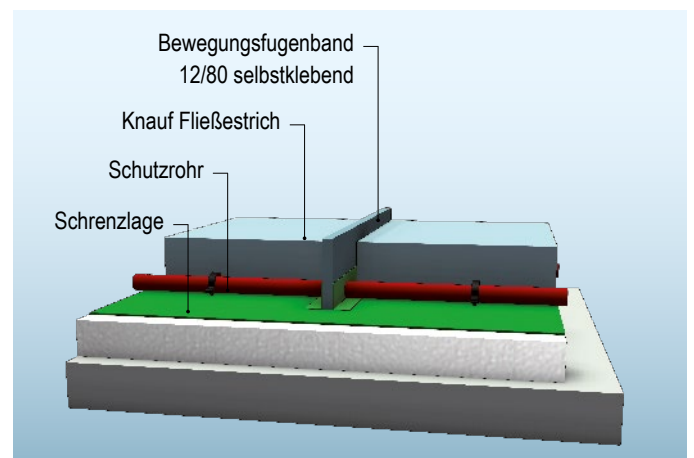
Ausführungsvariante 4: Fugen mit L-Profil
